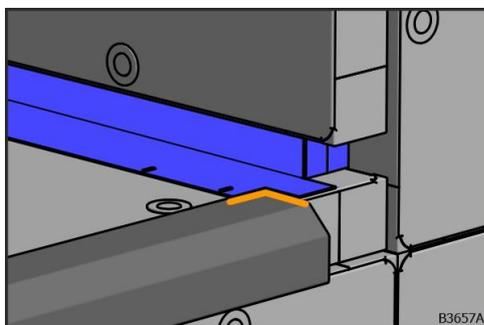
le cas échéant, mise en place de la cornière d'étanchéité
